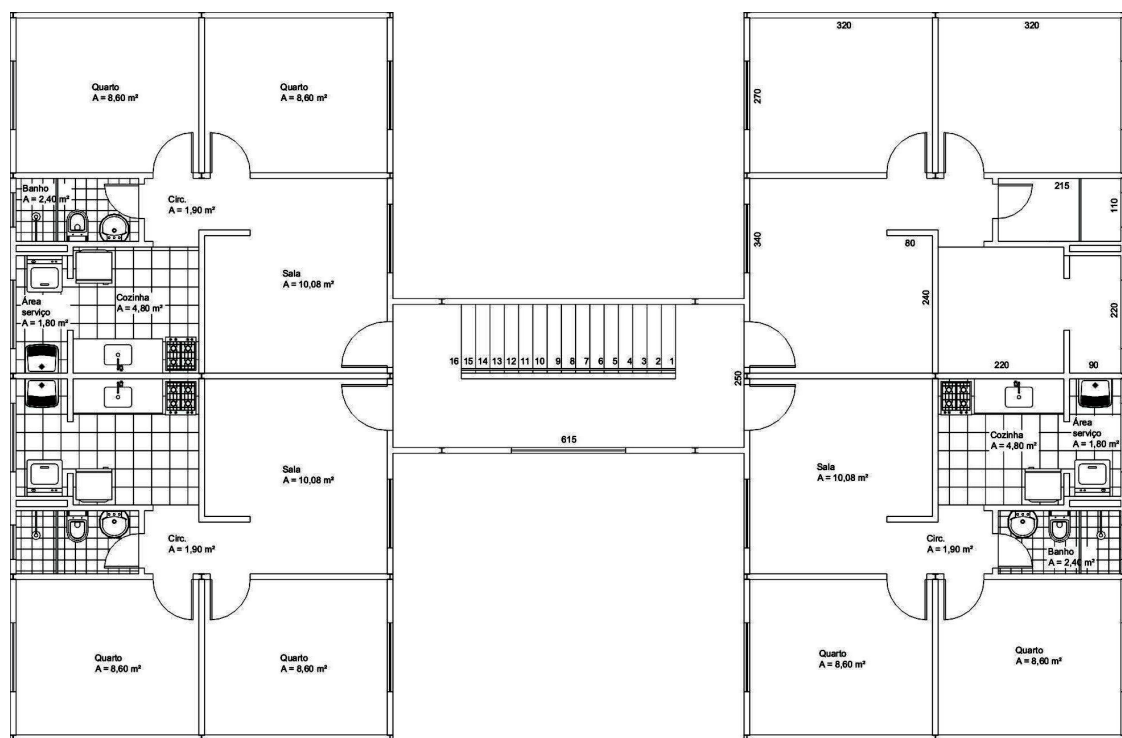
Planta baixa – pavimento tipo (Fonte: HERMSDORFF, 2005).
